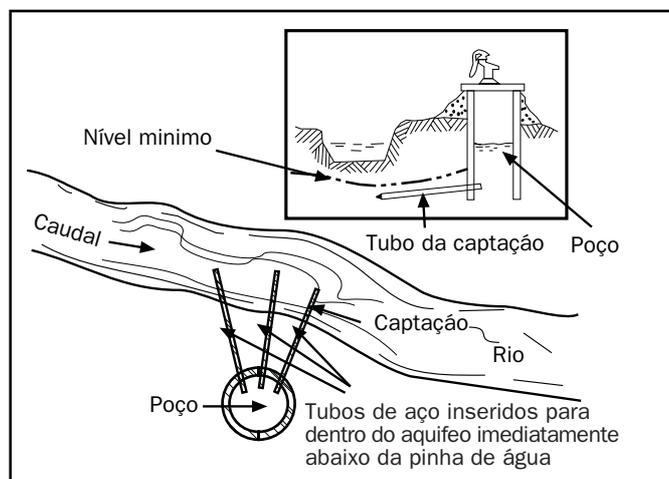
(f): Sistema de infiltração usando tubagem múltipla.
